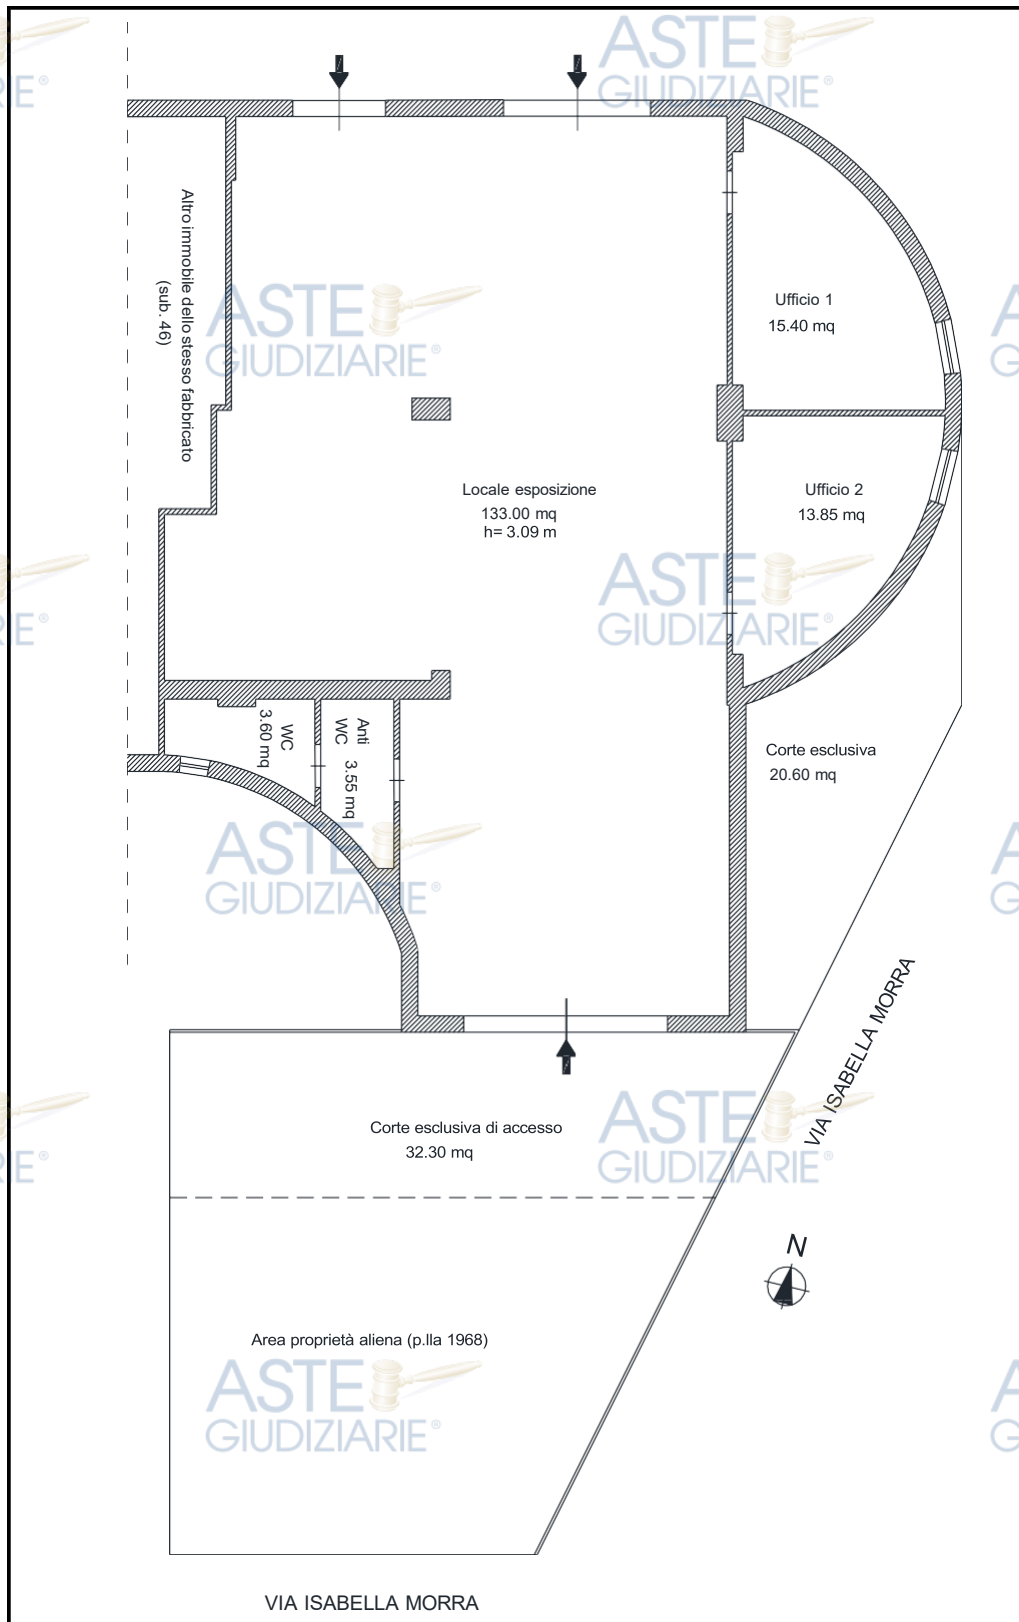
Pianta del locale commerciale in piano terra Lotto 1 (Fig. 74, p.lla 1852, sub. 13)
